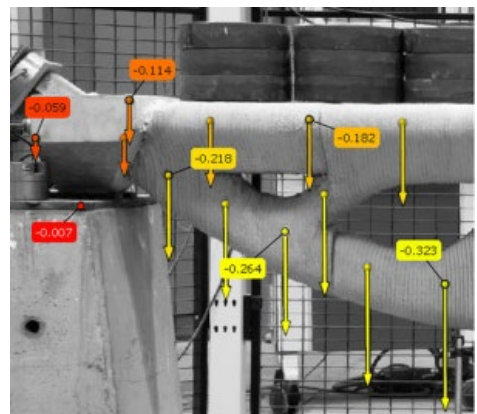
betongarmerte bjelker designet med strut-and-tie-modeller
